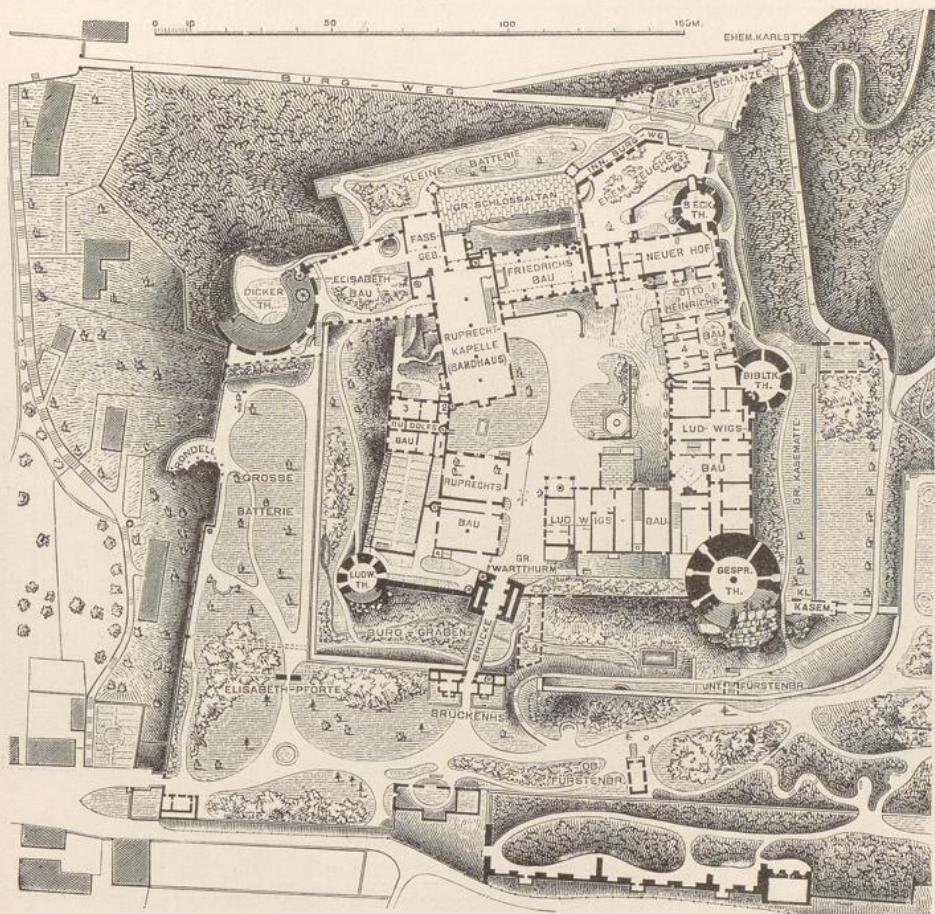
Das Schloß zu Heidelberg. Lageplan.
